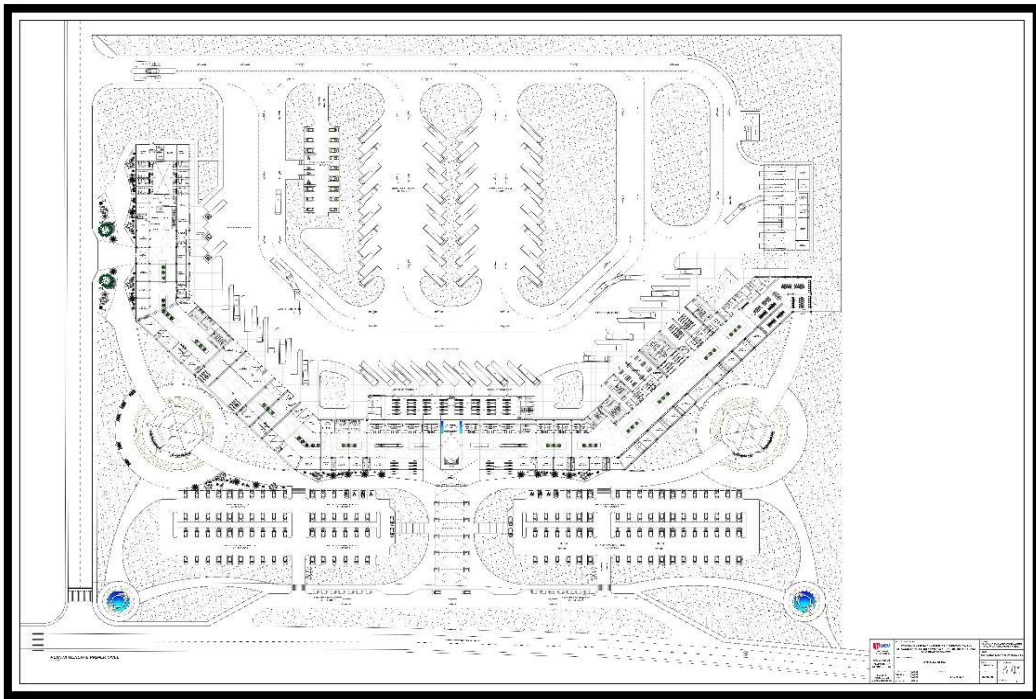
Plano Planta General - Fuente: Elaboración Propia.
